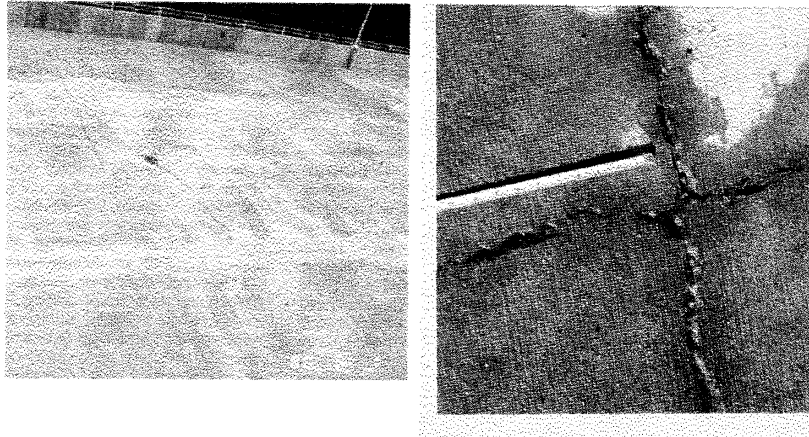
(a) Fissuração nas juntas de impermeabilização e (b) Lascamento de bordas (SCHUPACK;STANLEY, 1992).
